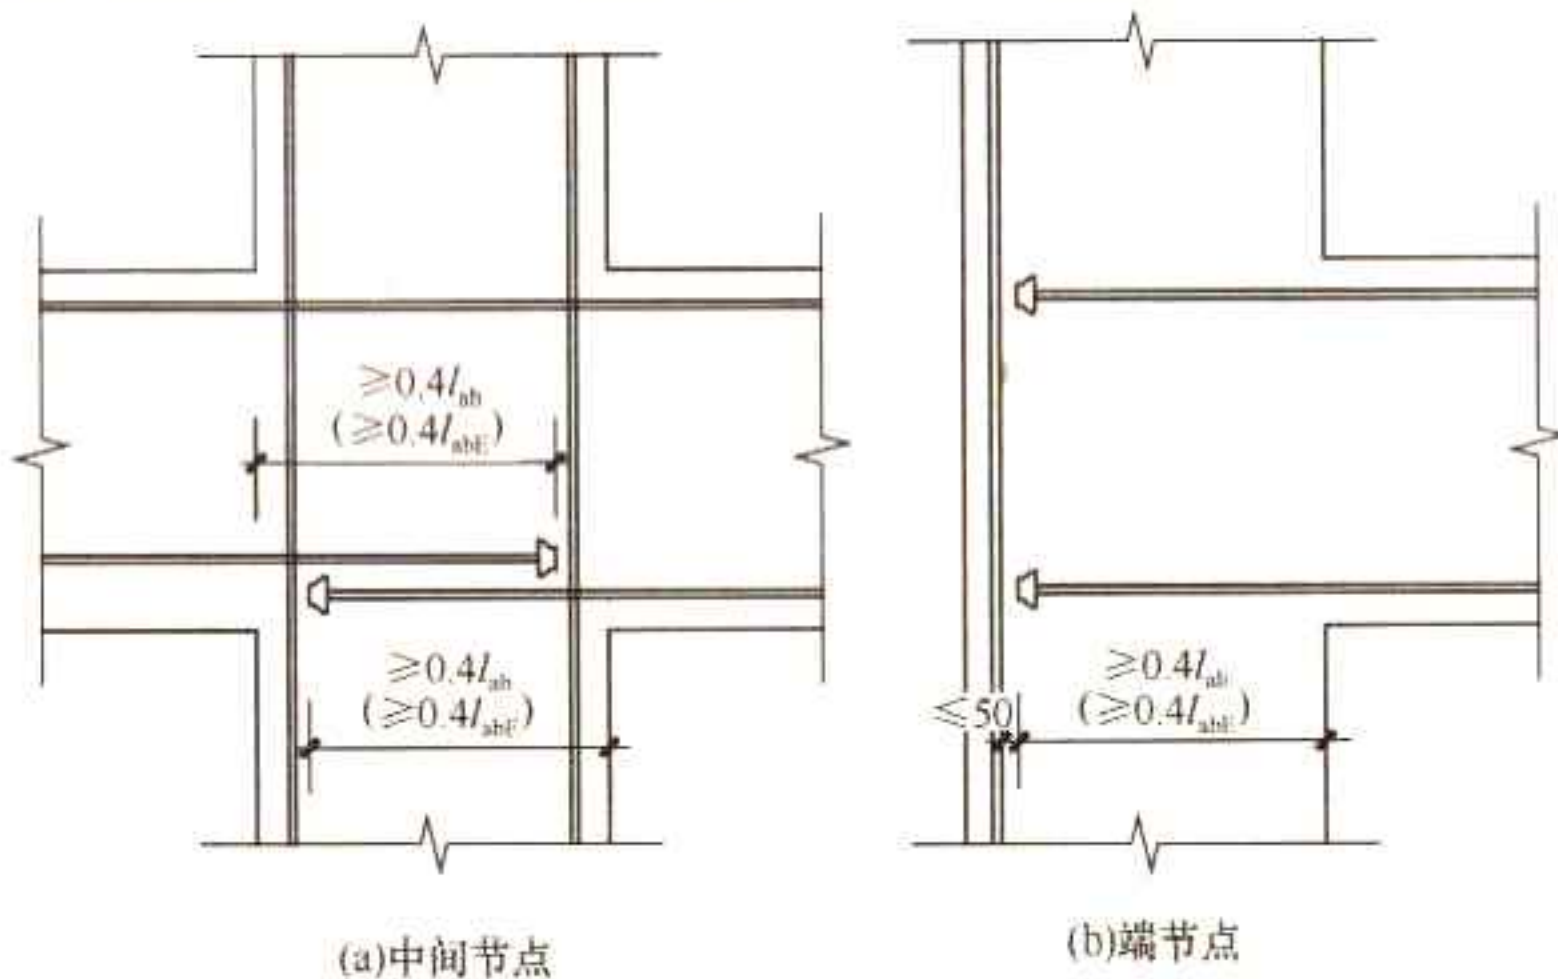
梁纵向钢筋在中间层节点的锚固
